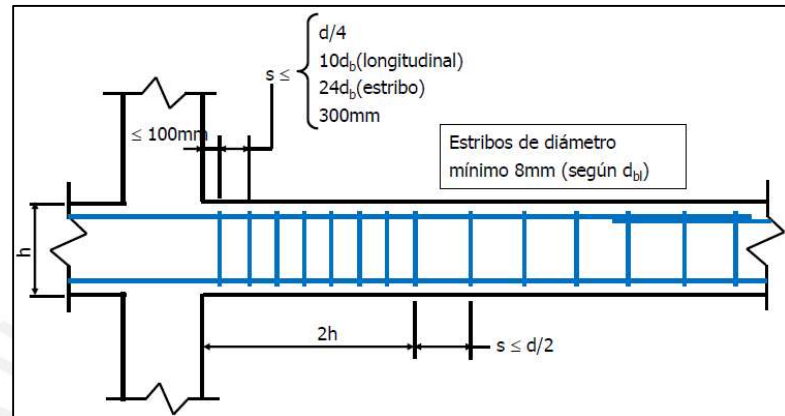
Requisitos para estribos en vigas (Edif. tipo muro o dual 1)
